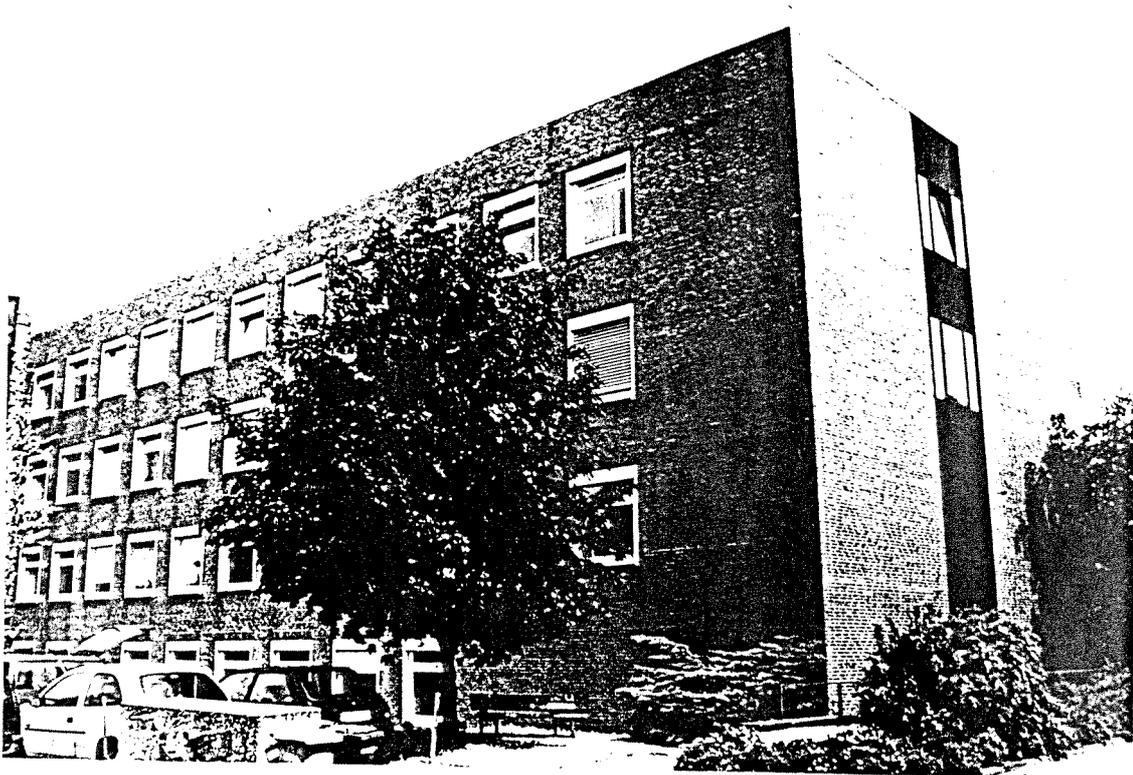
Fassadenansicht Gebäude B (sanierte Bereiche)
